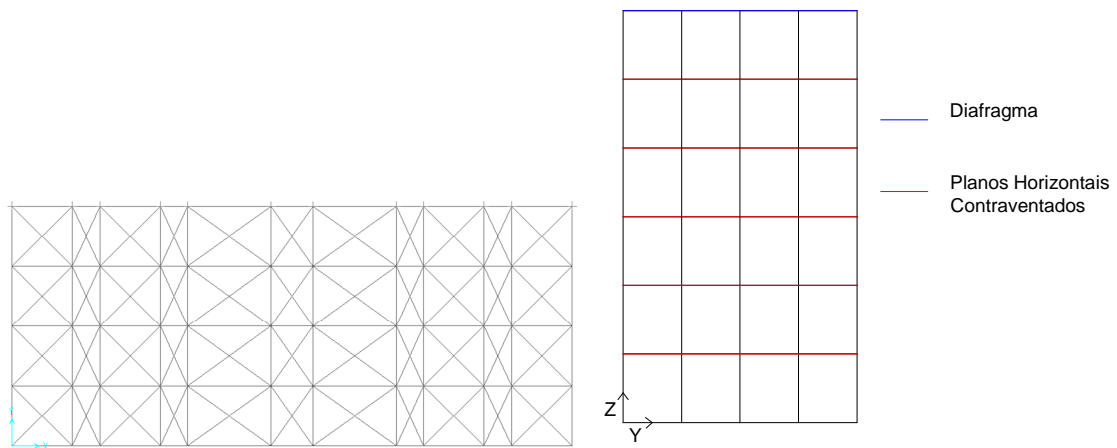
Configuração dos Planos de Contraventamento Horizontal Com Elementos de Contraventamento Pequenos
